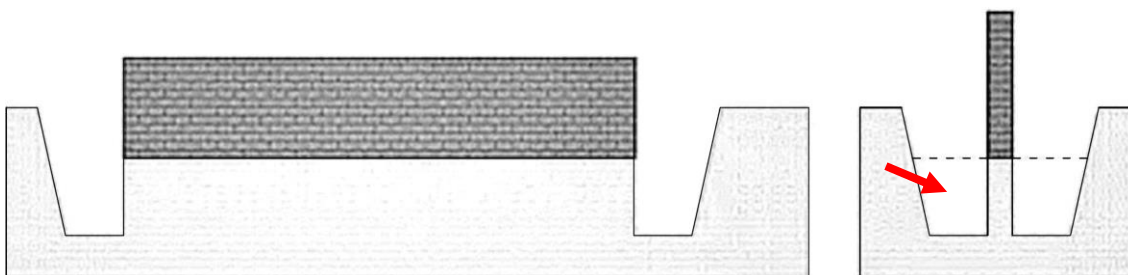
Scavo della doppia trincea intorno alla muratura perimetrale dell'edificio - Moussalli (2014).
